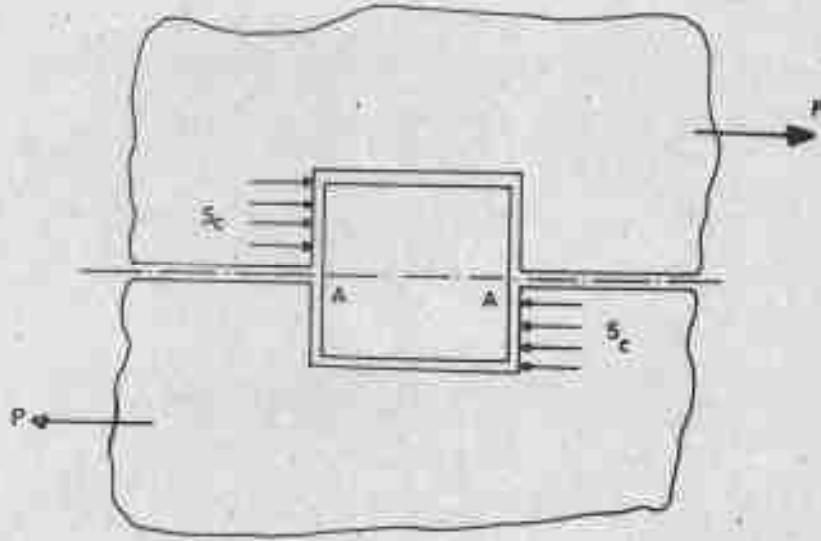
Hüsula ekvivalans görünüşü (a) plan
